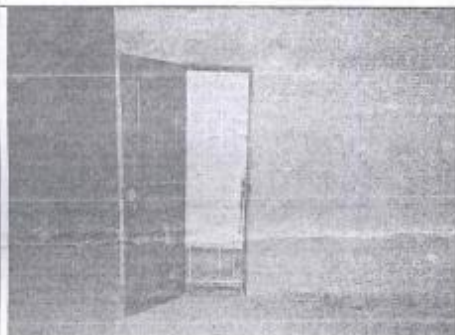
Se aprecia el acceso a las escaleras principales de la edificación.
